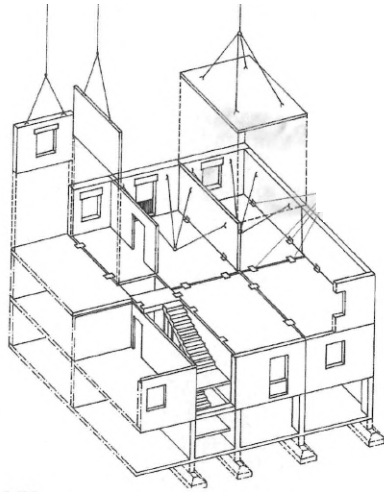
Schema di montaggio pannelli prefabbricati in calcestruzzo armato.
